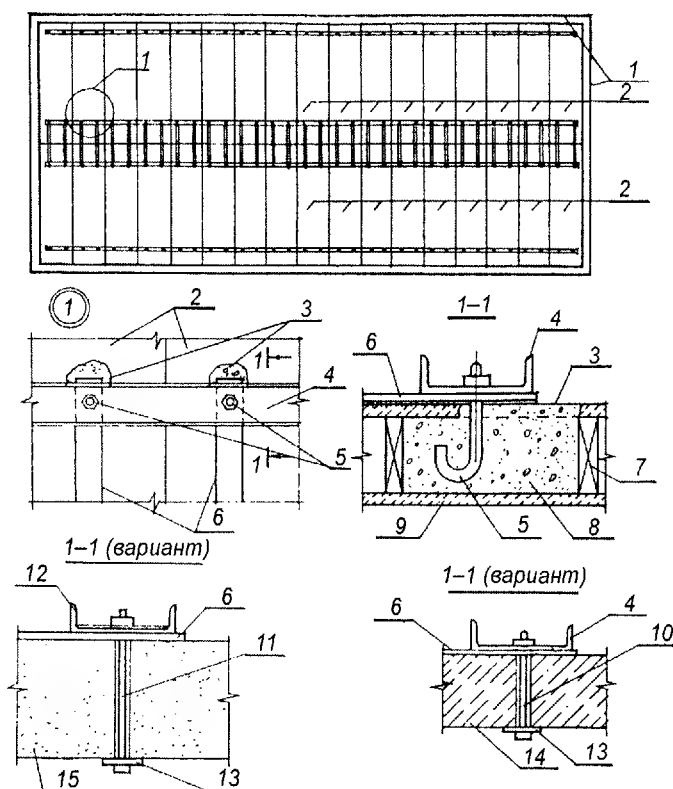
Схема устройства жесткого горизонтального диска в здании путем установки накладок из прокатного металла: 1 – стены здания; 2 – железобетонные панели; 3 – отверстия в полках панелей; 4 – пояс жесткости; 5 – анкерные связи; 6 – пластина-связь; 7 – заглушка; 8 – бетон замоноличивания; 9 – многопустотная железобетонная панель перекрытия; 10 – анкерный болт, установленный в отверстие, просверленное в панели; 11 – анкерный болт, установленный в отверстие, просверленное в шве между панелями; 12 – пояс жесткости из швеллера; 13 – шайба; 14 – сплошная железобетонная панель перекрытия; 15 – ребристая железобетонная панель перекрытия
